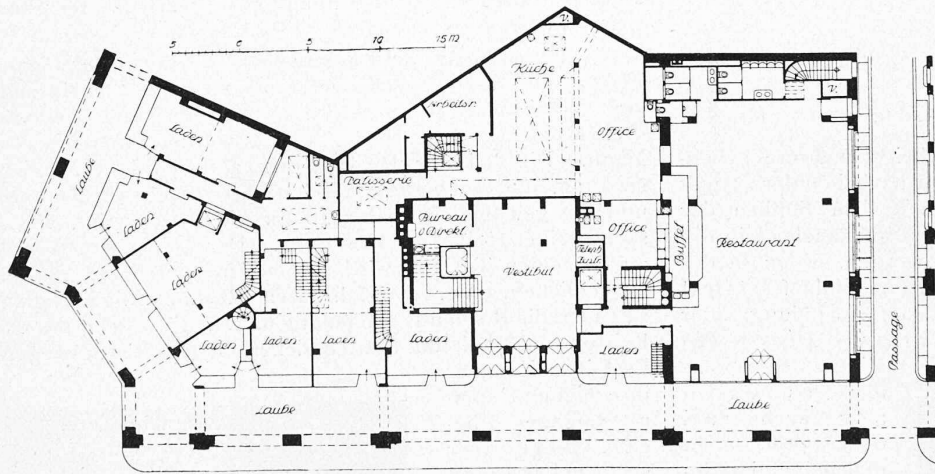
bis 7. Grundrisse vom Keller, Erdgeschoss und I. Stock. — 1:500.
